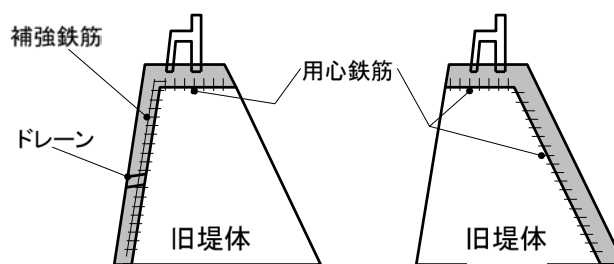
新旧コンクリートおよびコンクリート・鋼材部の一体化
